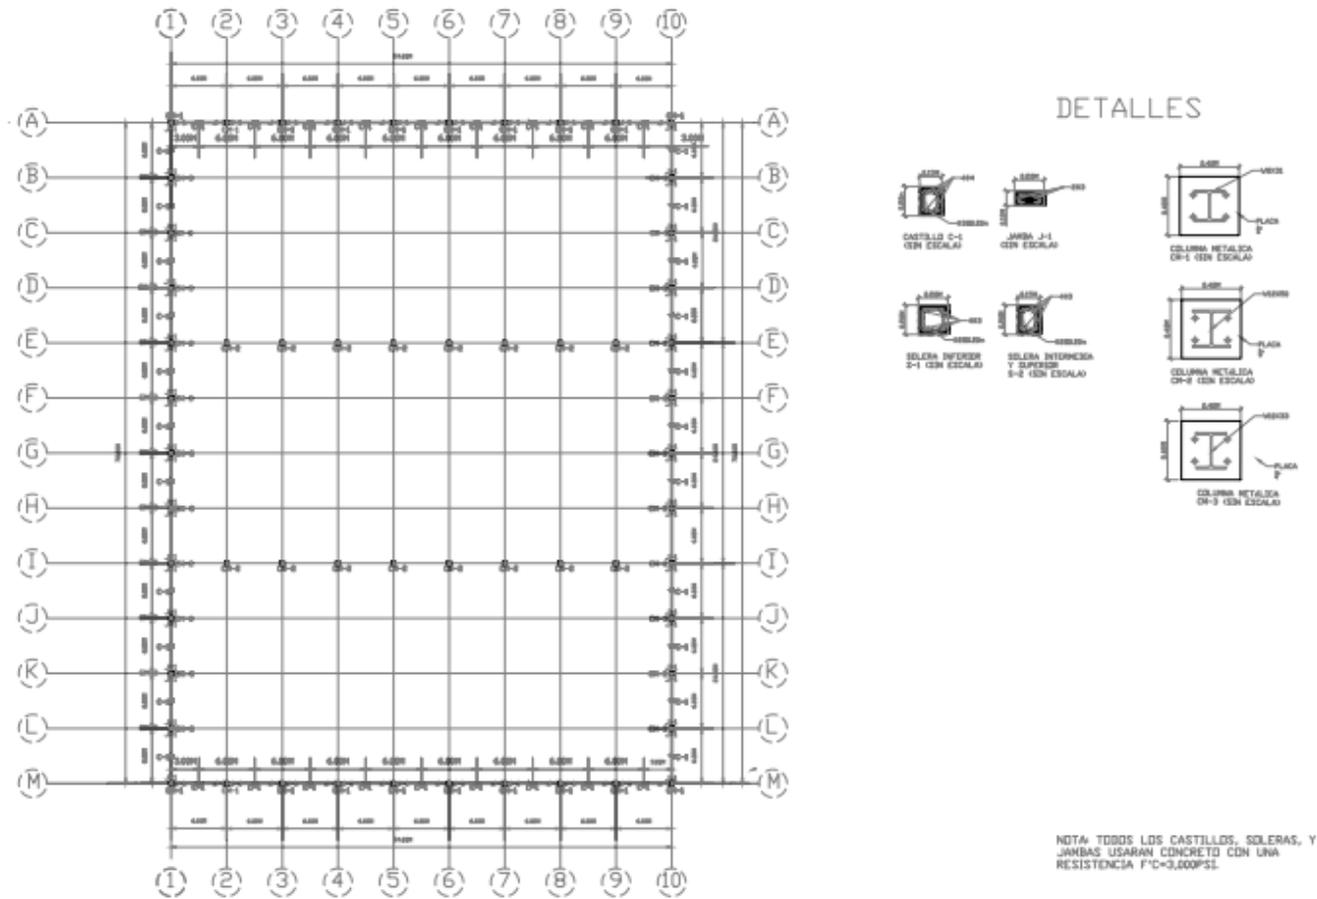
Plano Constructivo Nave 1 Ficasa
